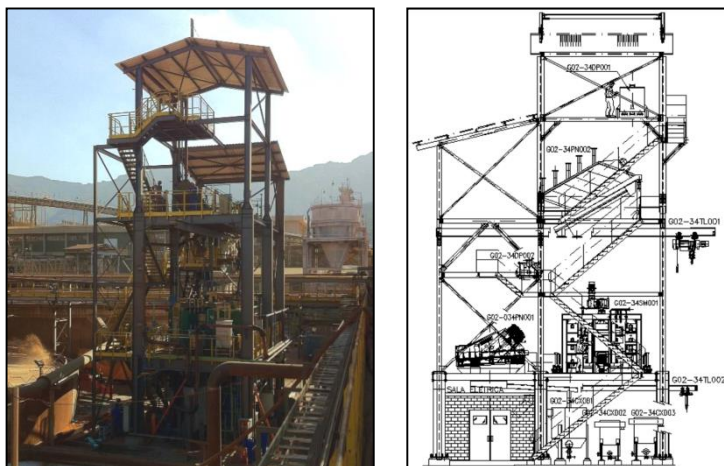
Planta semi-industrial projetada e construída para a execução dos ensaios.
